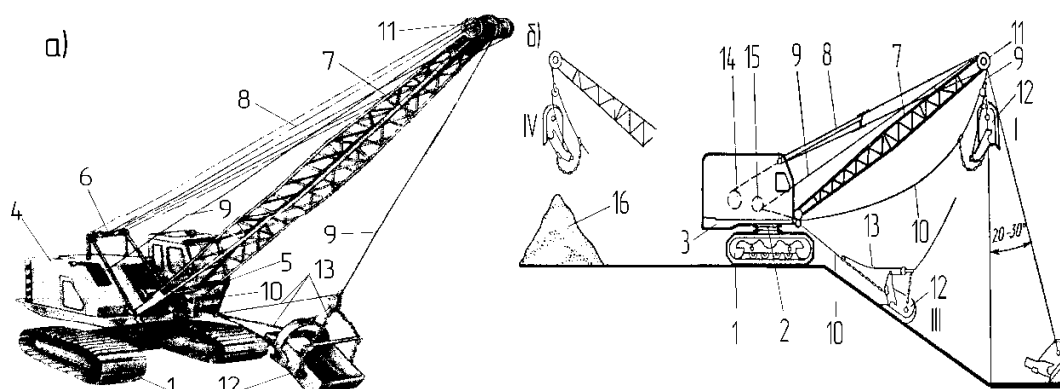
Экскаватор-драглайн: а) - общий вид; б) - конструктивная схема: 1 - гусеничное ходовое оборудование; 2 - опорно-поворотное устройство; 3 - поворотная платформа с противовесом; 4 - дизельный двигатель внутреннего сгорания; 5 - кабина машиниста; 6 - двуногая стойка с блоками; 7 - стрела; 8 - стреловой полиспаст; 9 - подъемный канат; 10 - тяговый канат; 11 - головные блоки; 12 - ковш; 13 - упряжь ковша; 14 - стреловая лебедка; 15 - главная лебедка; 16 - отвал грунта. I - подача ковша в забой поворотом стрелы; II - сброс ковша в забой; III - резание грунта (копание) с набором в ковш; IV - разгрузка ковша в отвал
